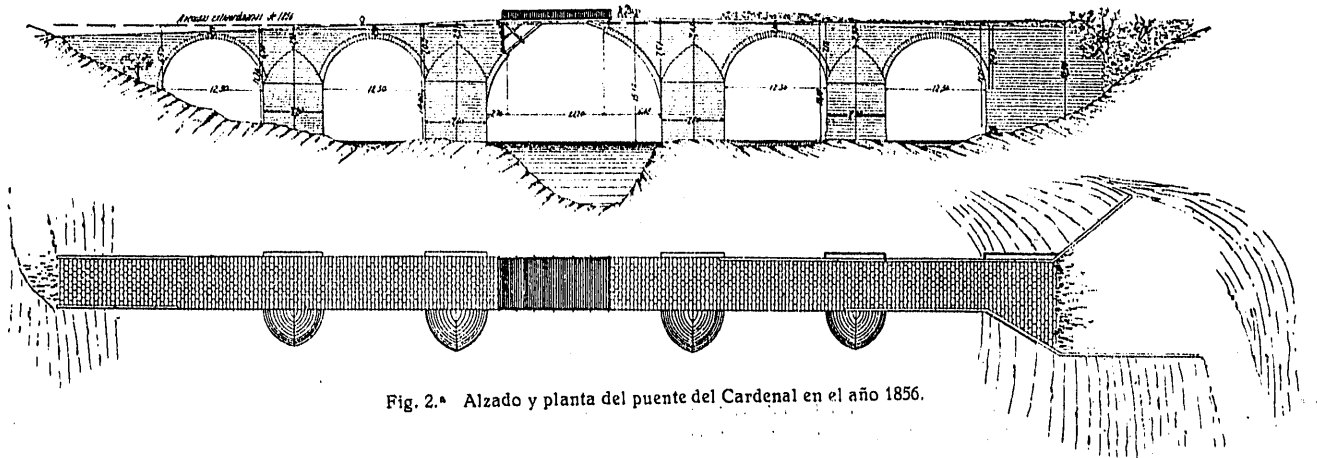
^a Alzado y planta del puente del Cardenal en el año 1856.
